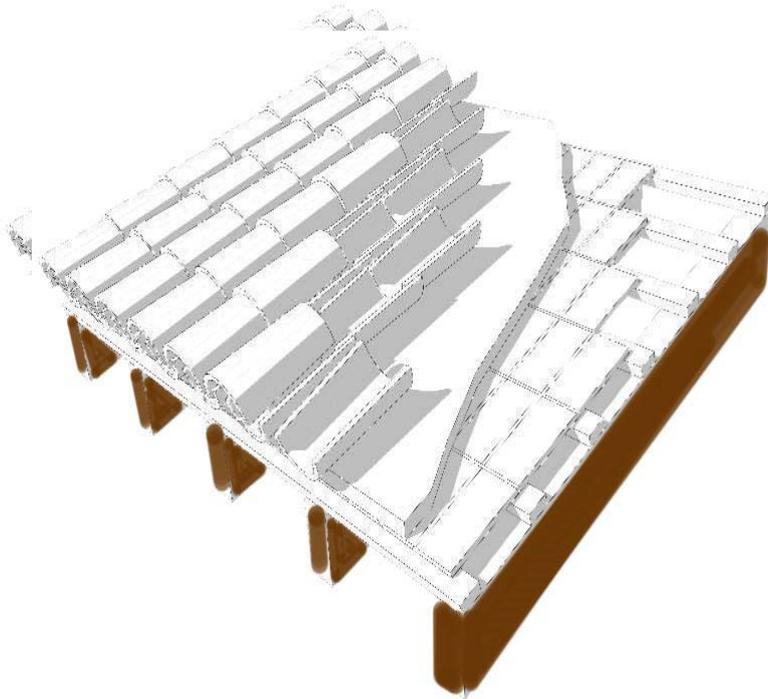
Detalle constructivo de la cubierta. Fuente Propia. 2016
